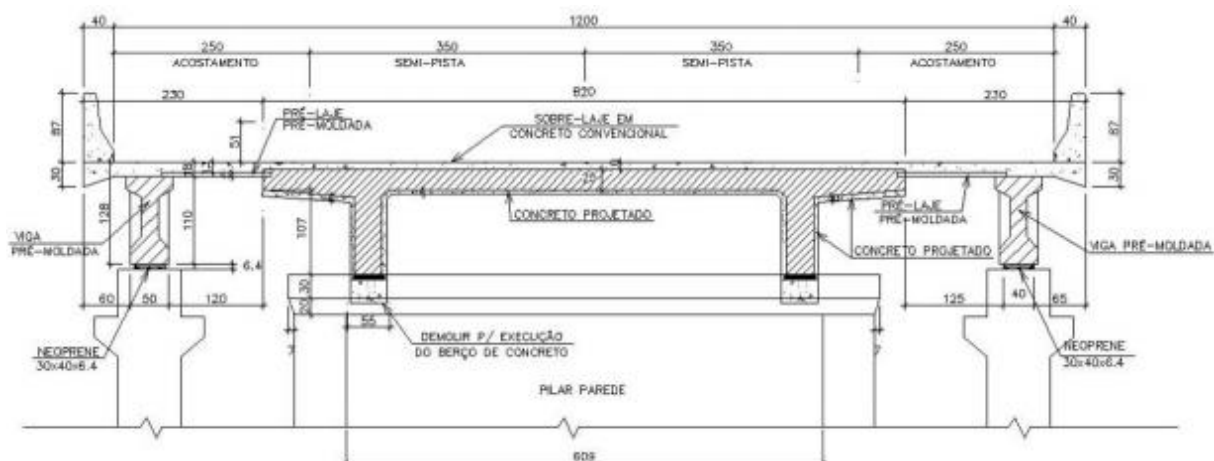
Alargamento de uma ponte utilizando viga pré-moldada
